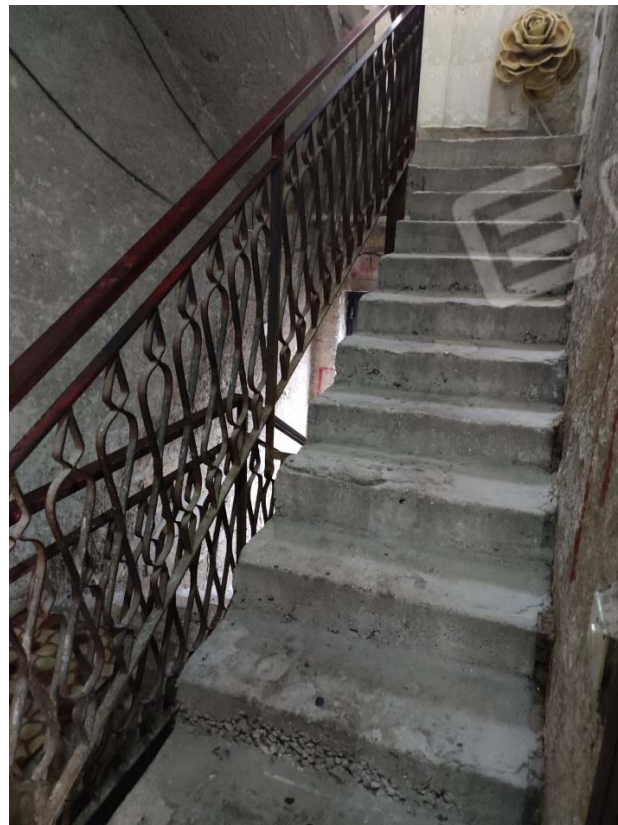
Vista palazzina con accesso dal civ. 27
